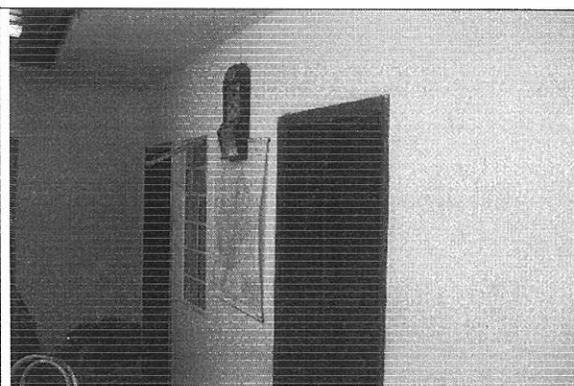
Muros internos en buenas condiciones de la edificación 32 - 10
